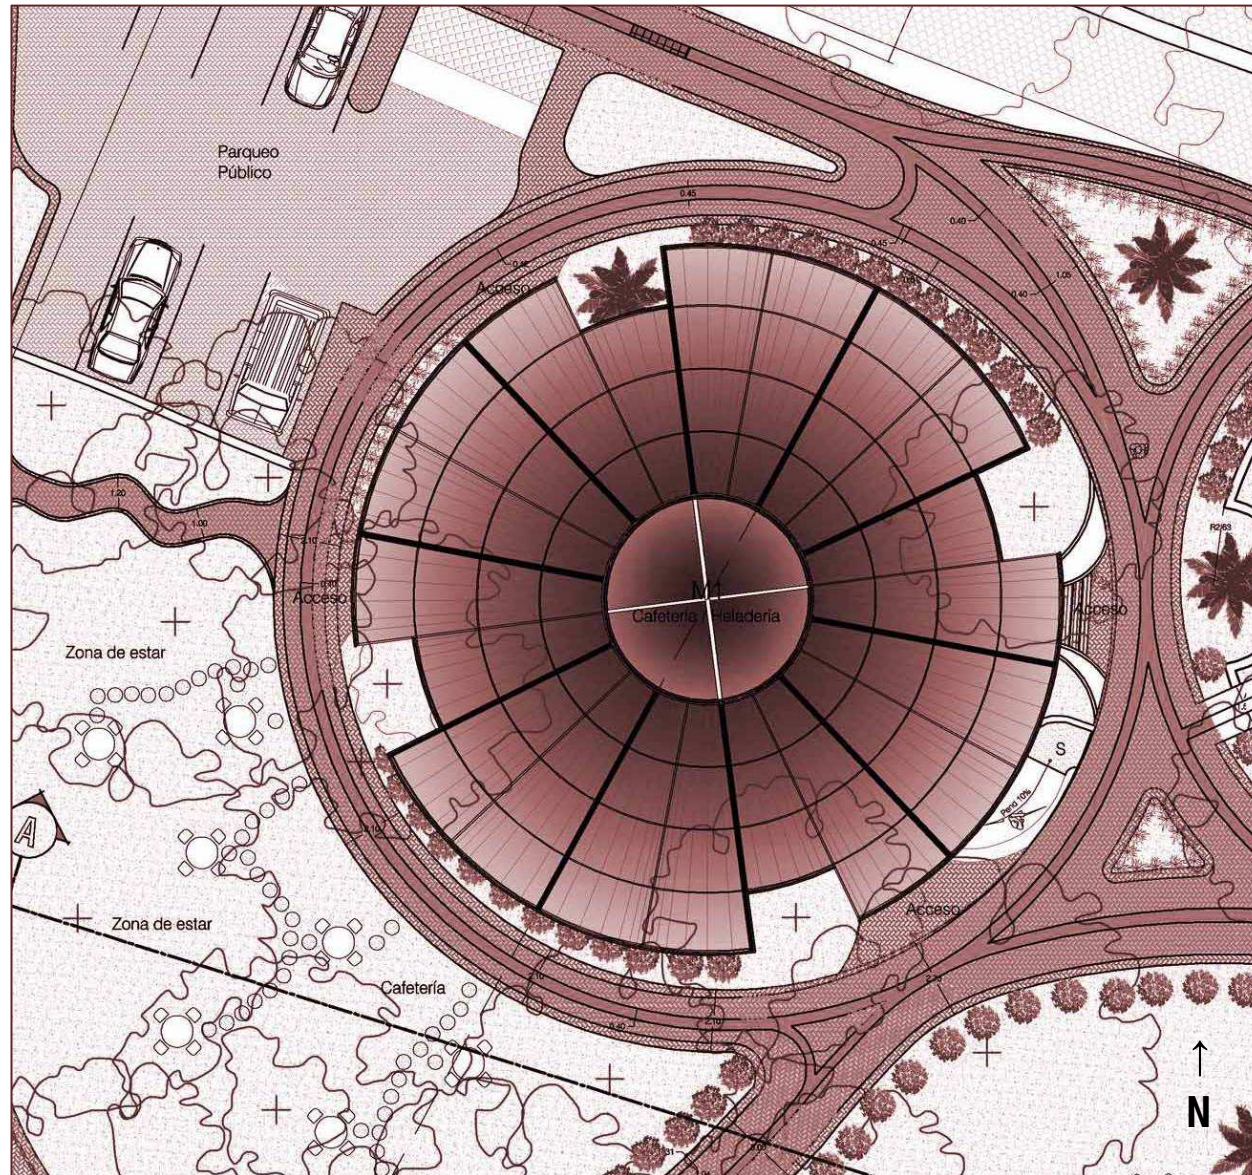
Módulo 1.Panta de techos .Heladería-Cafetería
